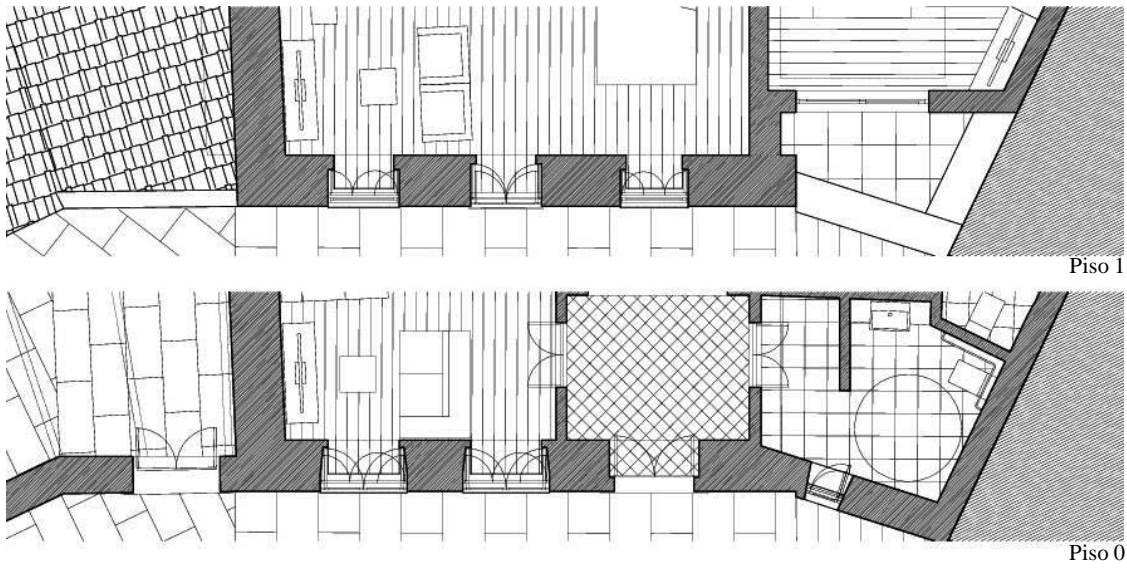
Opção a) esquema de funcionamento em planta e alçado
